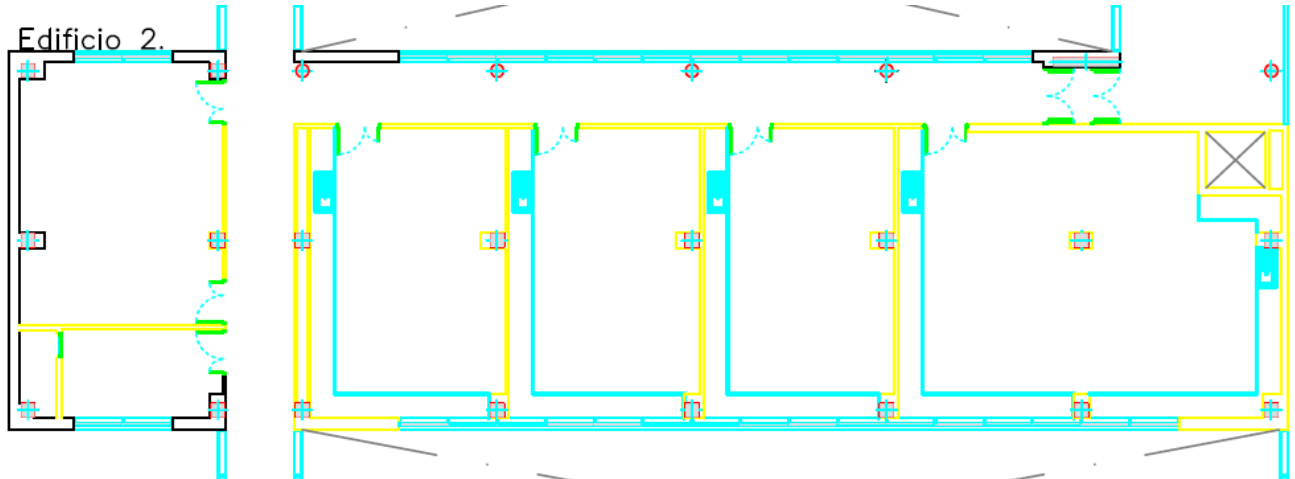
Vista en planta del primer nivel del edificio 2 de Pleiades.
